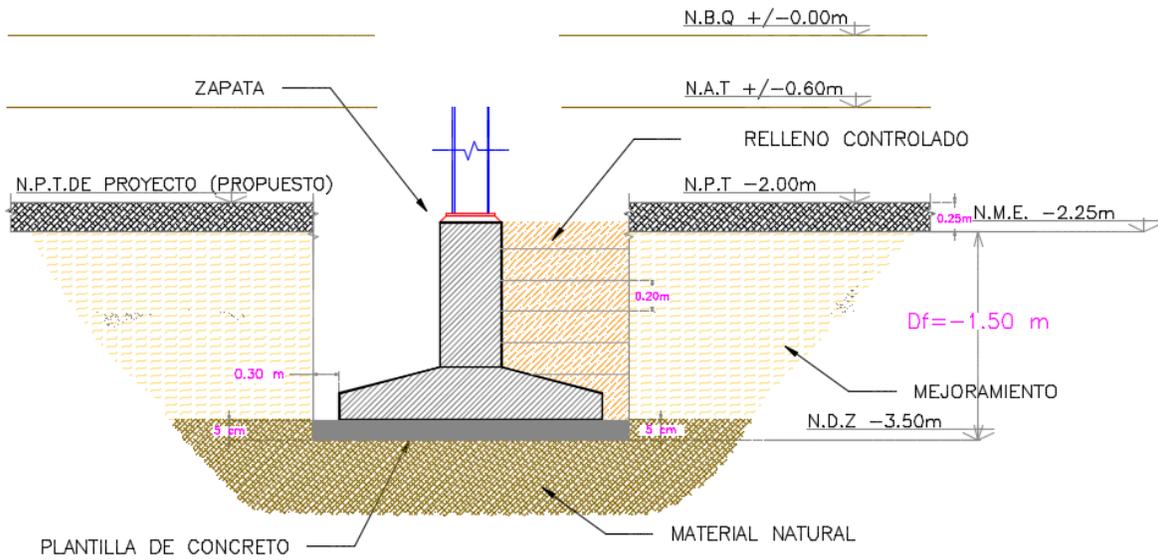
ALTERNATIVA DE CIMENTACIÓN MEDIANTE ZAPATAS AISLADAS CENTRALES Y ZAPATAS CORRIDAS APOYADAS SOBRE MATERIAL NATURAL
